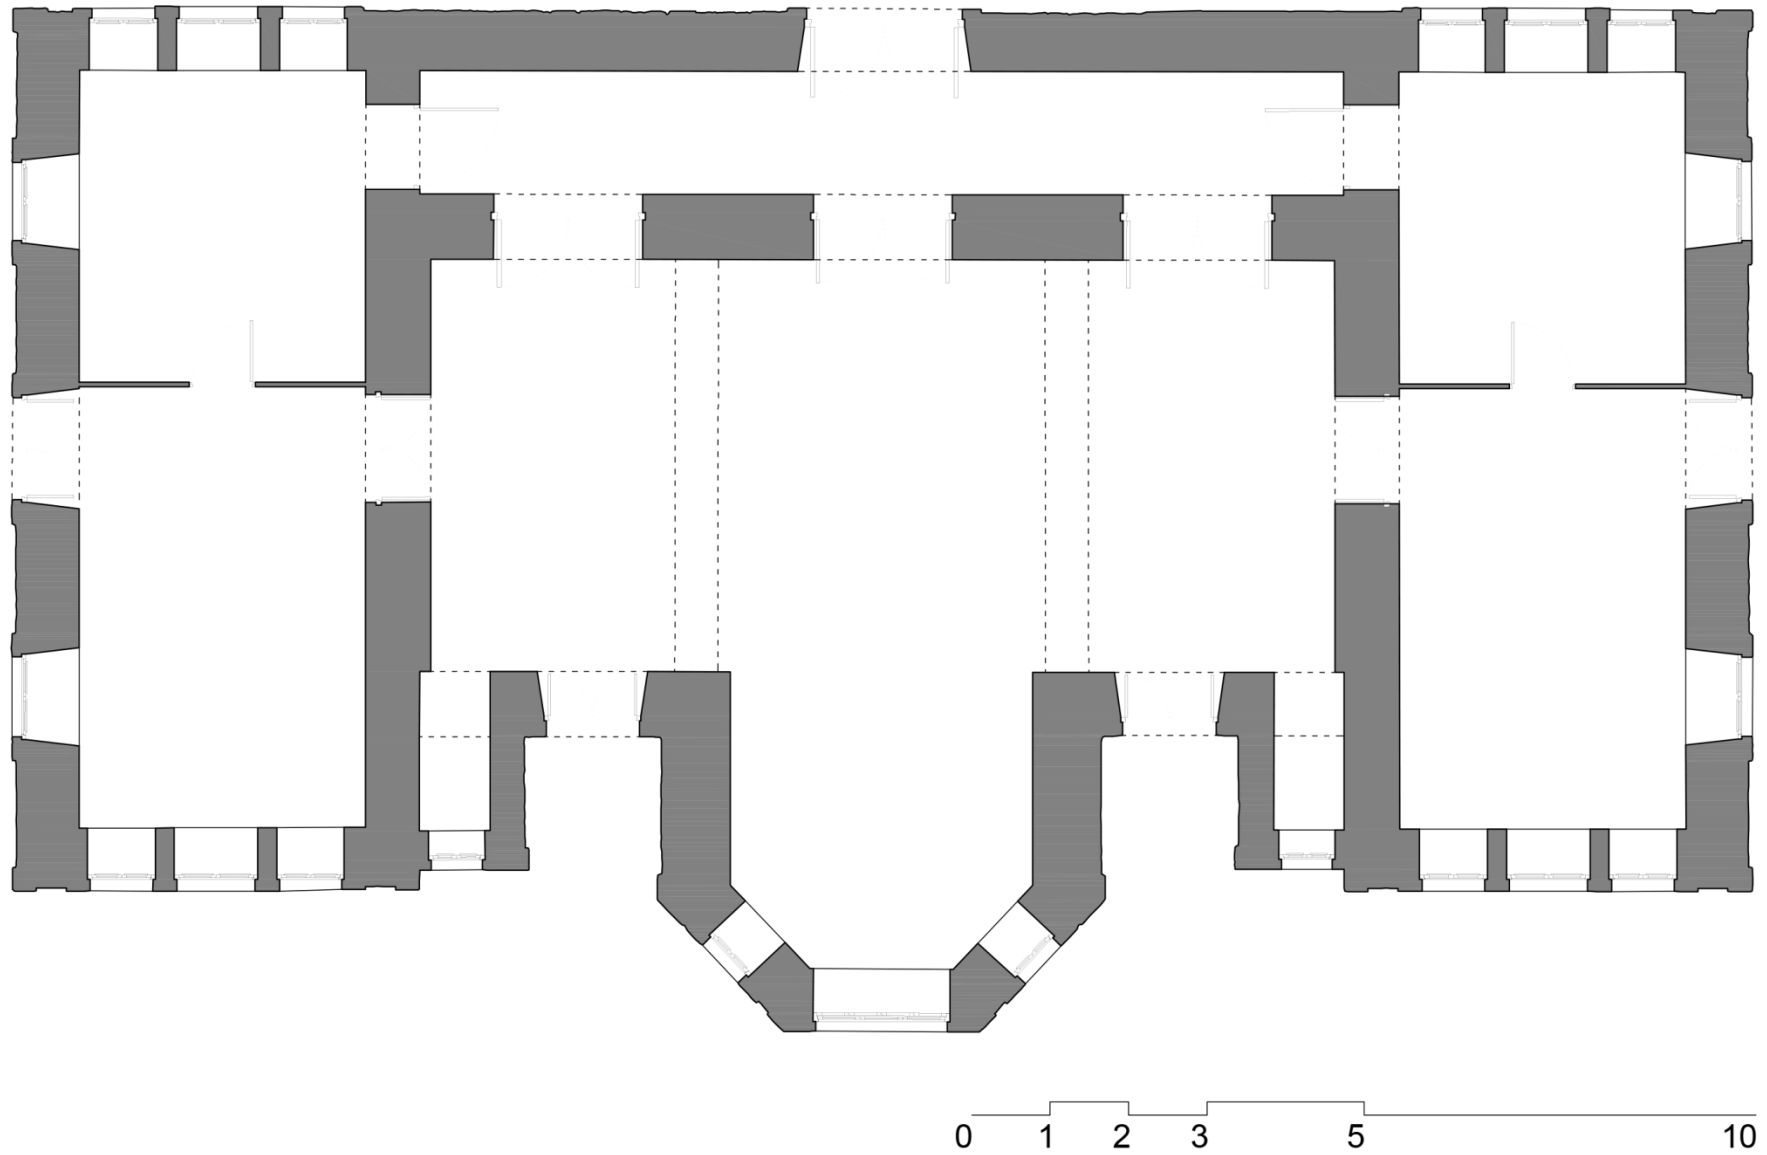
Plano sección horizontal planta baja. Estado original. Escala gráfica.
